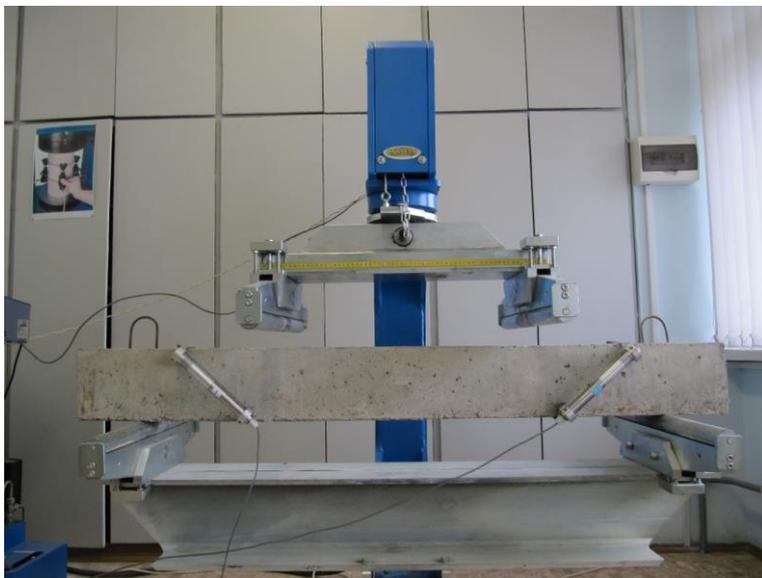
Испытание балки с разрушением по наклонному сечению
